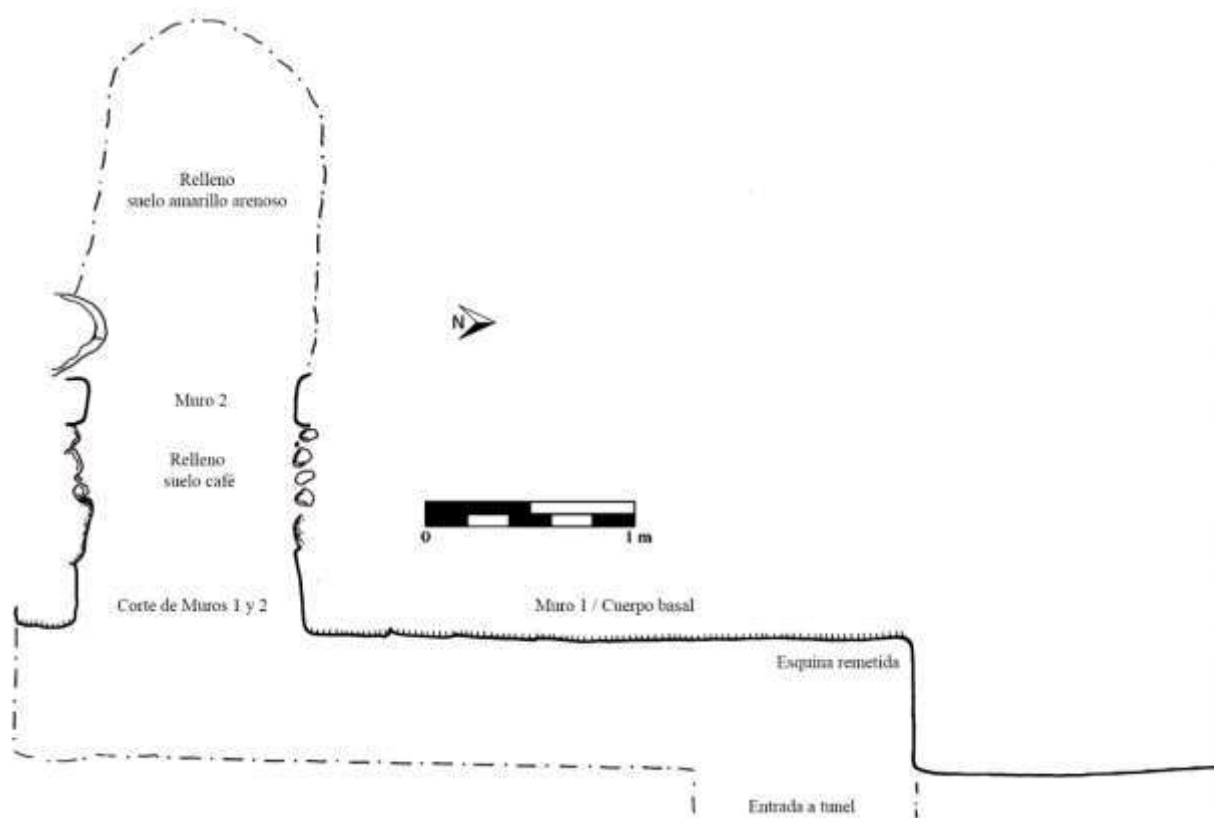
Dibujo de planta que muestra el corte muros 1 y 2 del cuerpo basal de fachada oeste (posterior) de la Estructura 13Q-1 (Dibujo por A. Cajas).
